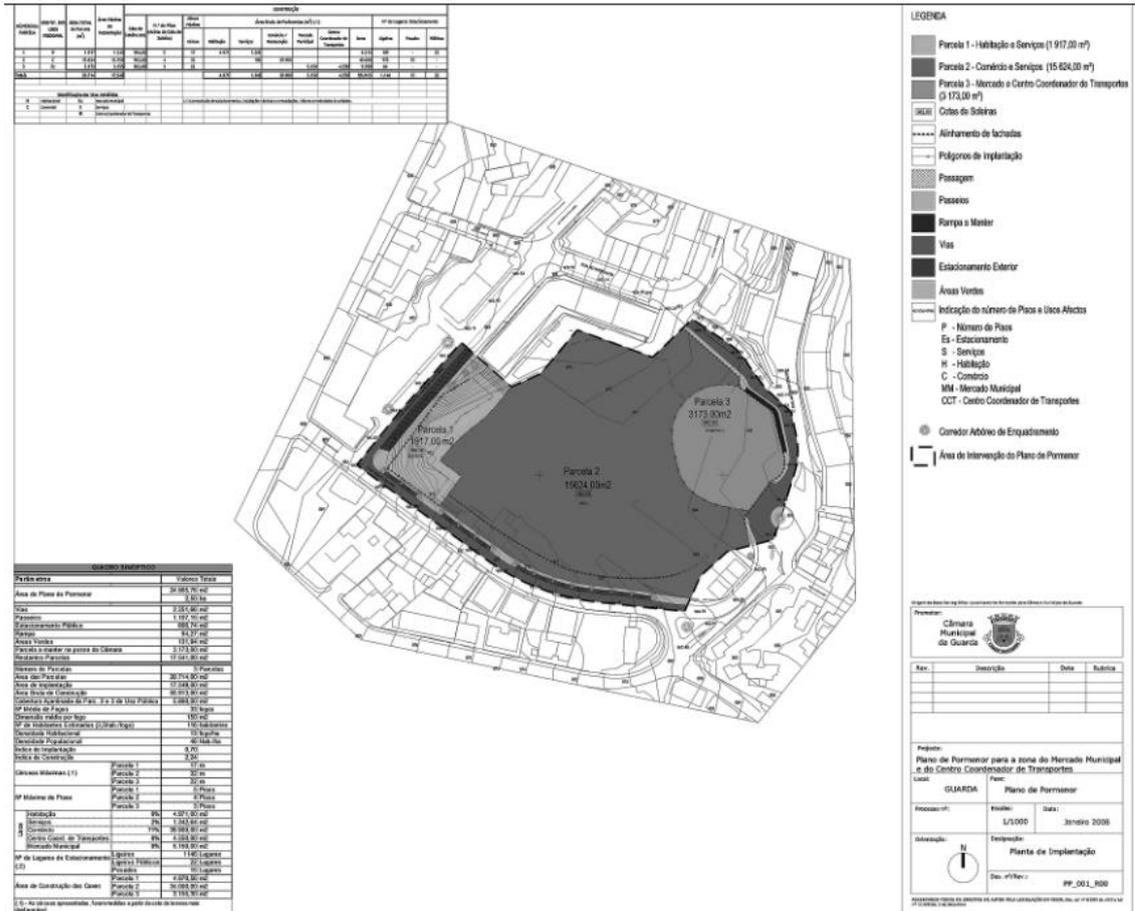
Plano de Pormenor para a Zona do Mercado Municipal e Centro Coordenador de Transportes – Planta de Implantação
